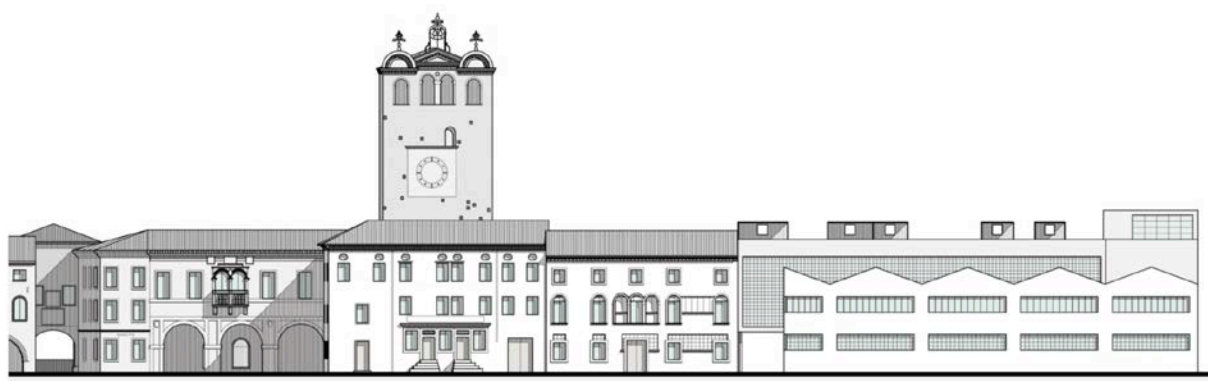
Prospetto principale di progetto, dal lavoro dello studente Gregorio Xausa.
